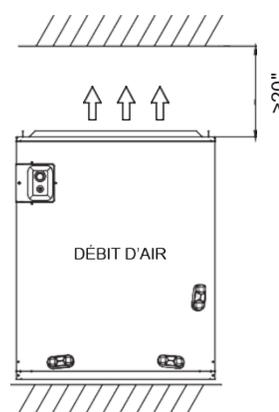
Vue avant du dégagement de l'unité intérieure (y compris les conduits d'air)
